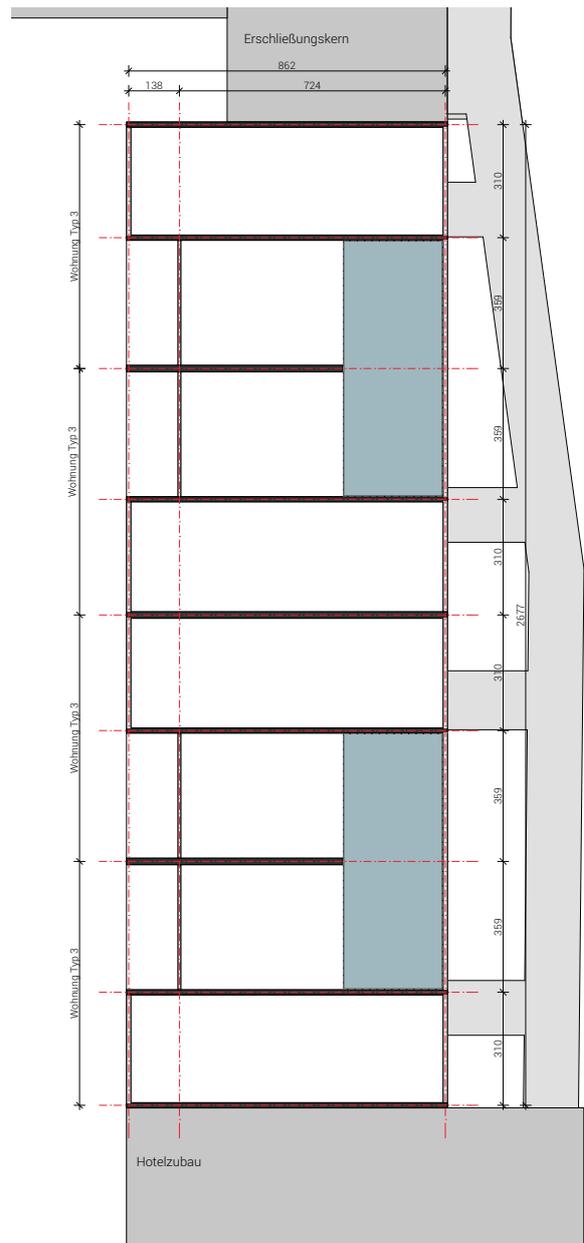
Grundriss Regelgeschoss BT B
